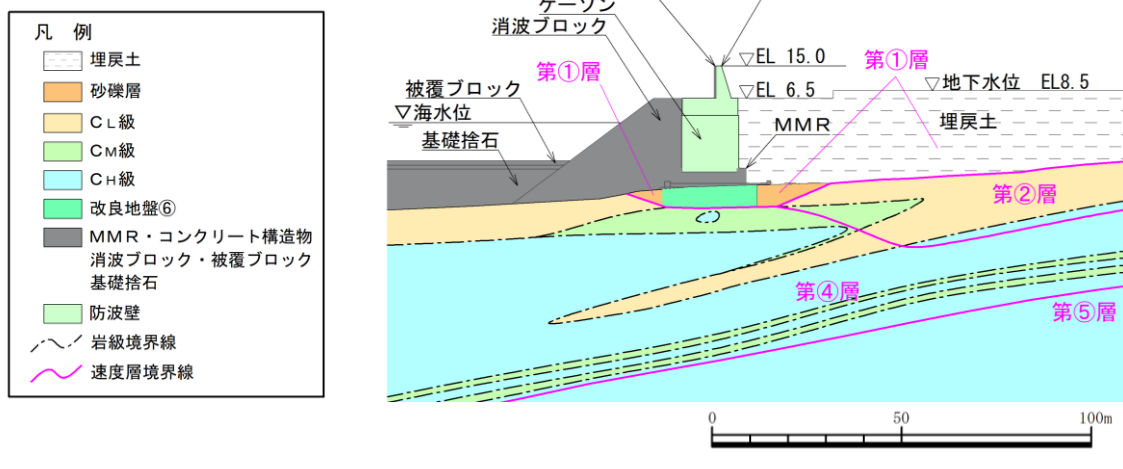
(2) 地質断面図 (防波壁 (波返重力擁壁) ②-②断面)
